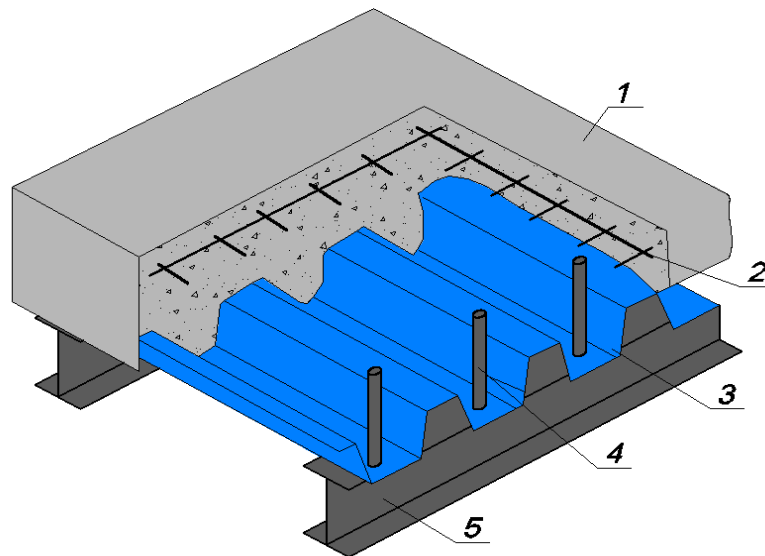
Сцепление бетона и стального профилированного настила при помощи анкеровки: 1 – бетон, 2 – арматурная сетка, 3 – стальной профилированный настил, 4 – вертикальный анкер, 5 – прогон
